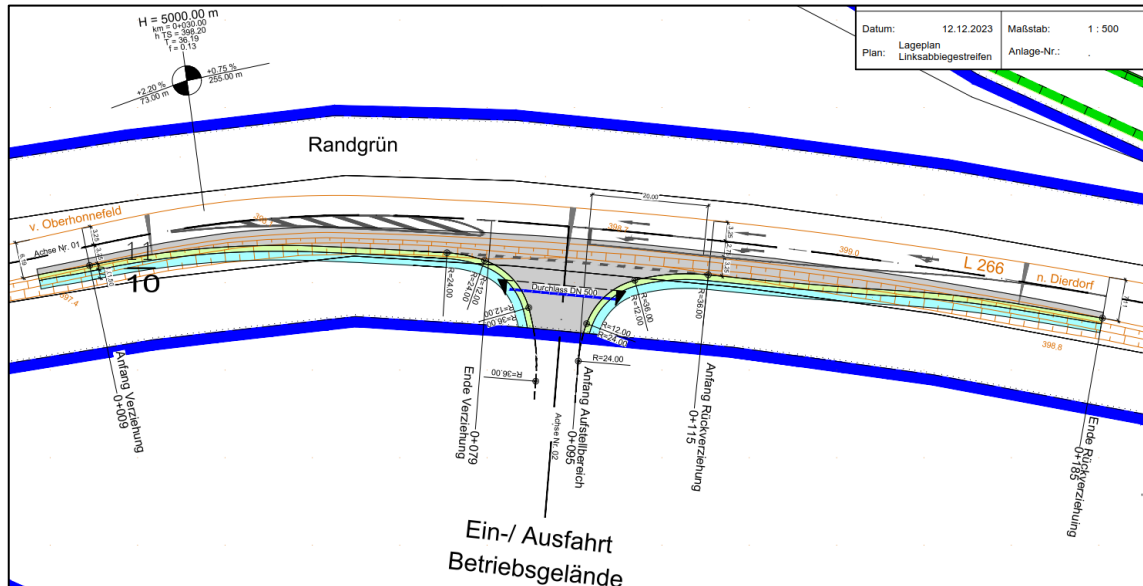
Auszug aus dem Lageplan / Fahrbahnaufweitung für die Linksabbiegespur (Planungsbüro Dittrich, 12.12.2023)
